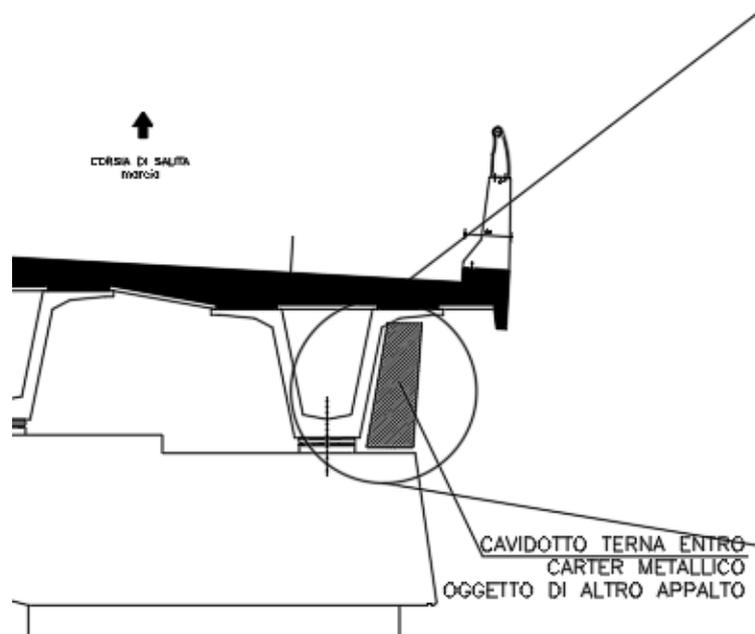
Sezione viad. Perilleux impalcato di salita con posizionamento nuovo cavidotto impianti TERNA (oggetto di altro appalto).
